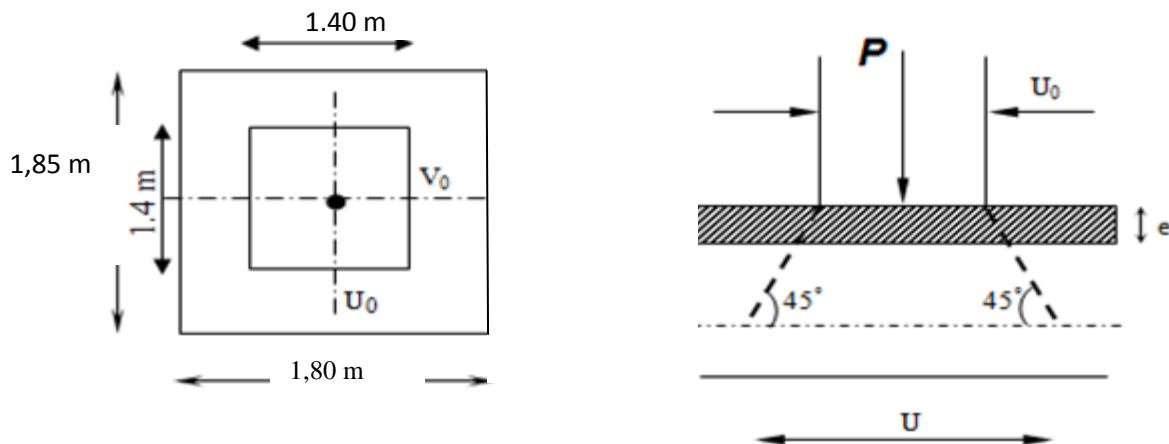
Caractéristiques géométriques de la dalle pleine de la salle machine.
